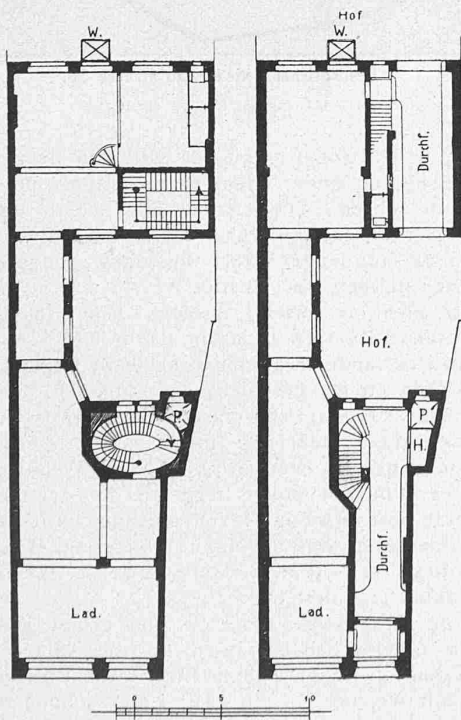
u. 10. I. Obergeschoss, 1:400. Erdgeschoss.
